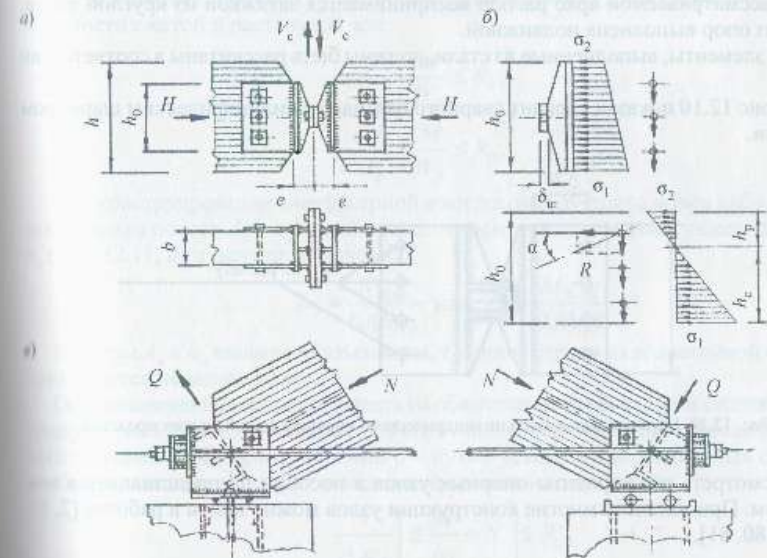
Вариант узлов арок с затяжкой пролетом более 30 м: а – конструкция «плиточного шарнира»; б – варианты расчетных усилий в узле; в – конструкция опорных узлов с одной подвижной опорой
